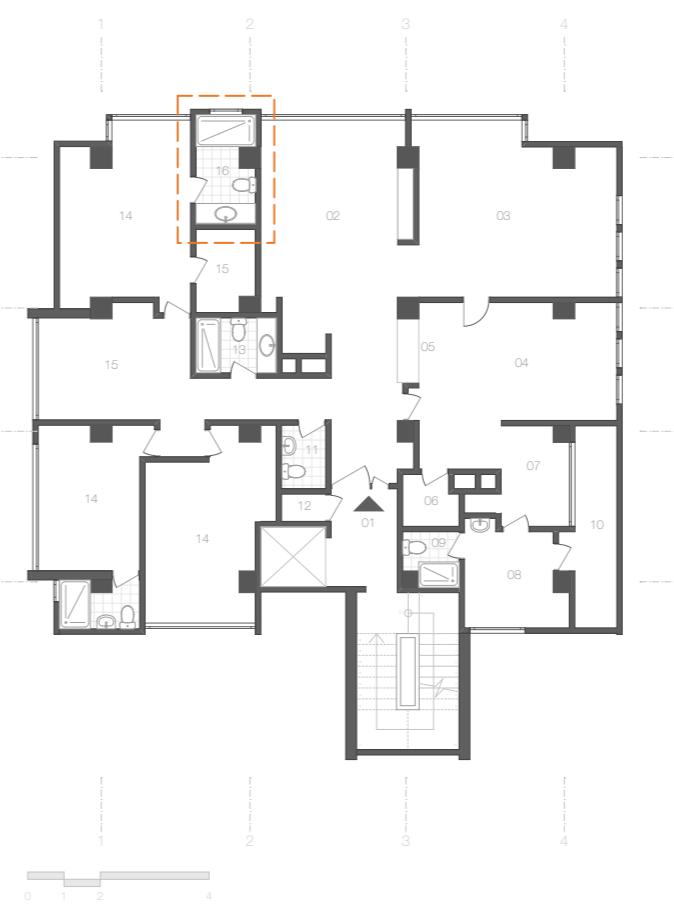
Sección Condominio Los Sauces Planta Tipo
